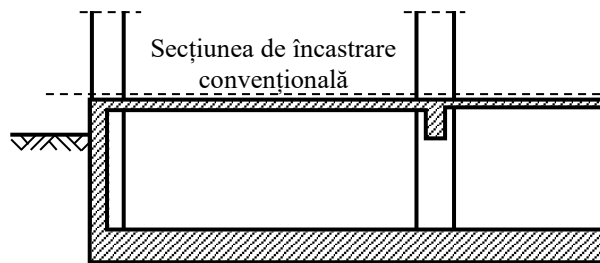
Reprezentare exemplificativă privind poziționarea secțiunii de încastrare convențională la clădiri cu subsol, cu perete perimetral de beton continuu
